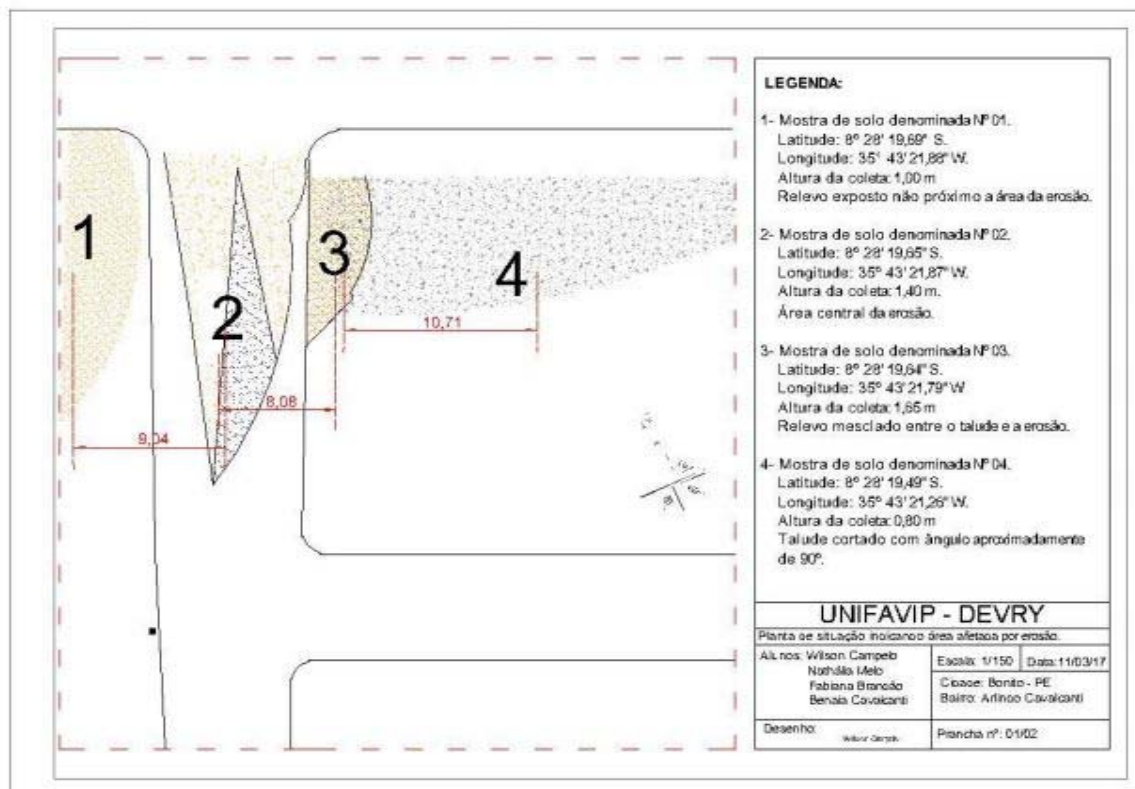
Cópia da Planta de situação mostrando a área afetada pela erosão. Fonte: Os autores.
